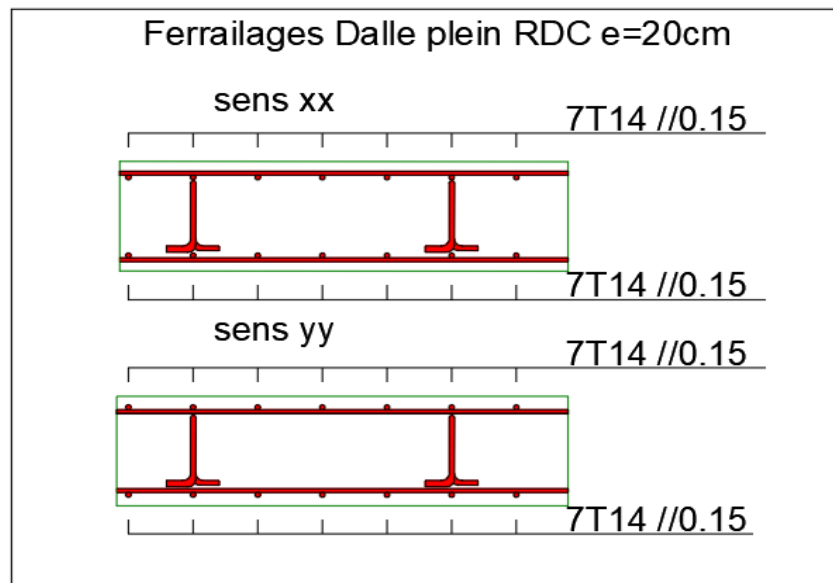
Schéma de ferrailage pour la dalle RDS.
